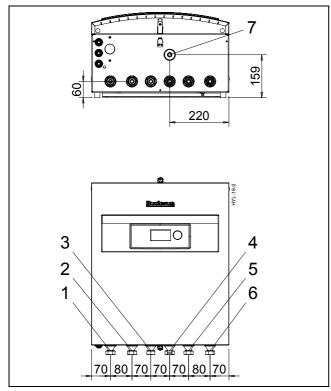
Allacciamento del Modulo idraulico interno AW (dimensioni in mm)
